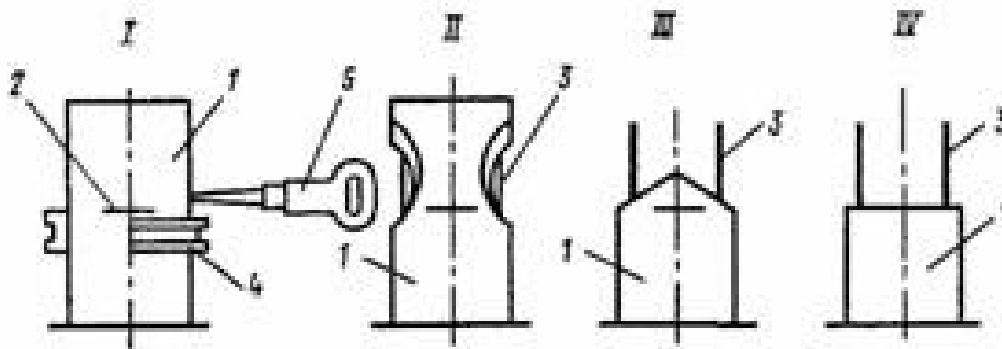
Порядок срубki сваёй. I-установка хомута; II- вырубание бетона по углам сваи; III- срубka головы сваи; IV- подготовка сваи к установке оголовка или заделке в ростверк. 1-свая; 2- риска (отметка линии срубki головы сваи); 3-продольная арматура; 4-монтажный обжимной инвентарный хомут (на II-IV этапах монтажный обжимной хомут условно не показан); 5-отбойный молоток.
